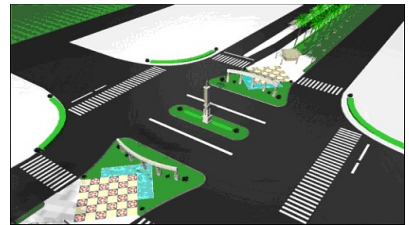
Projeto de revitalização da Avenida Goiás – Praça do Bandeirante.
